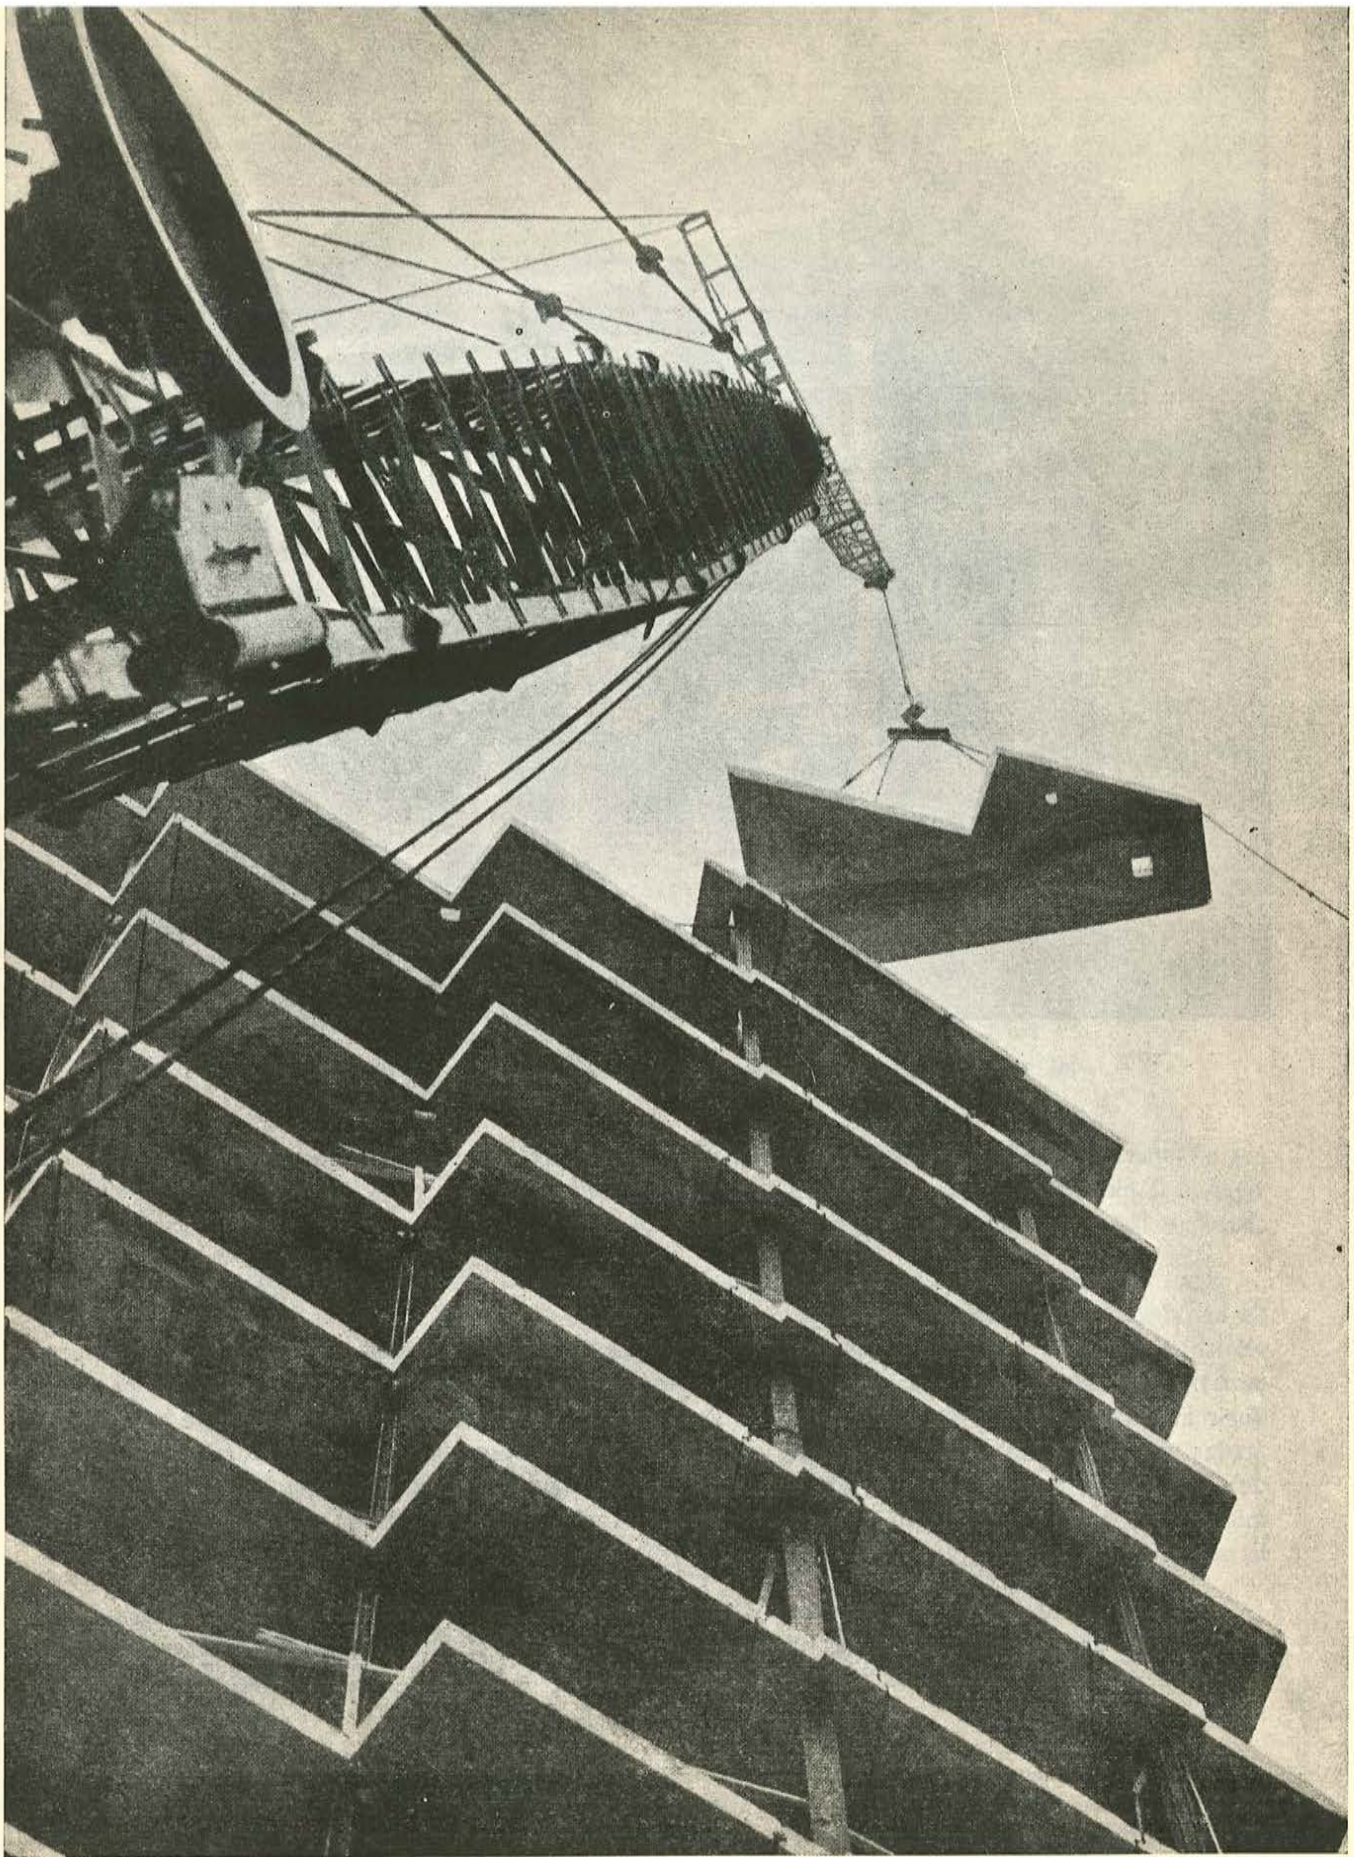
Elevación y colocación, en una de las últimas plantas, de una losa de forjado pretensada y prefabricada.
